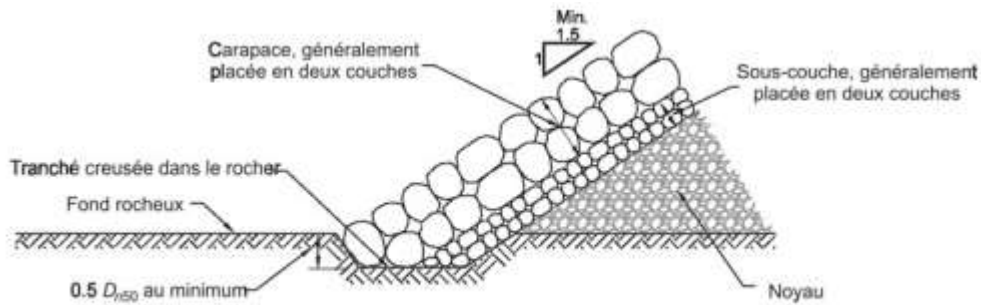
Détail d'un pied - 1b Fond rocheux: excavation d'une tranchée
